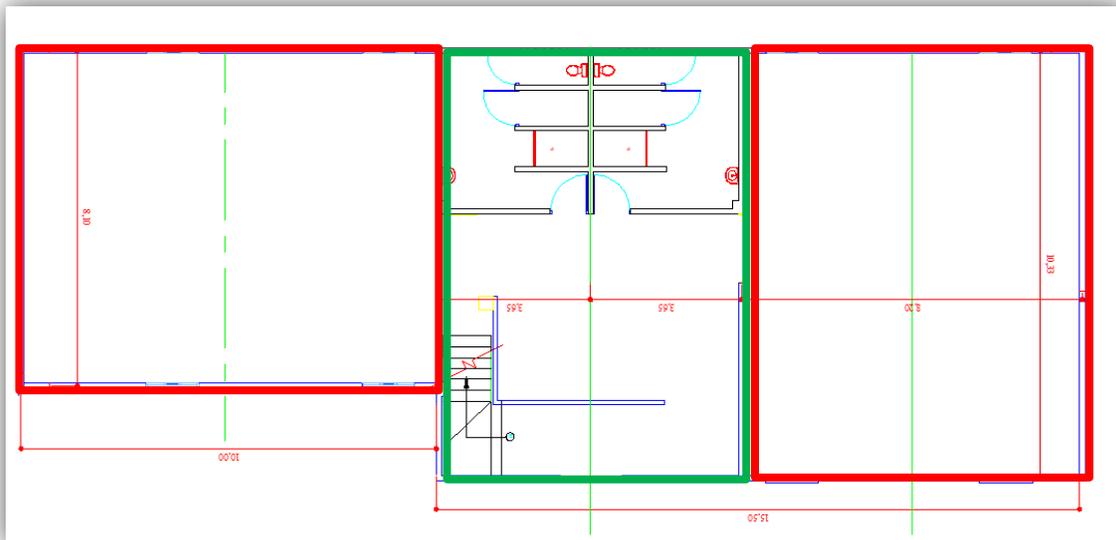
Esquema salón de arte dramáticas – Bloque B9
